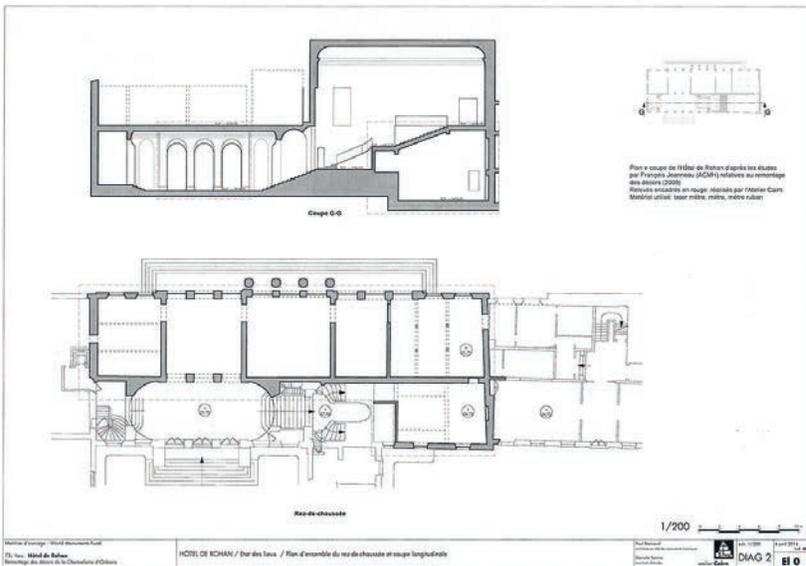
Parigi, Hôtel de Rohan-Strasbourg, sezione longitudinale e pianta d'insieme del rez-de-chaussée, stato attuale (arch. Paul Barnoud, 2014).
